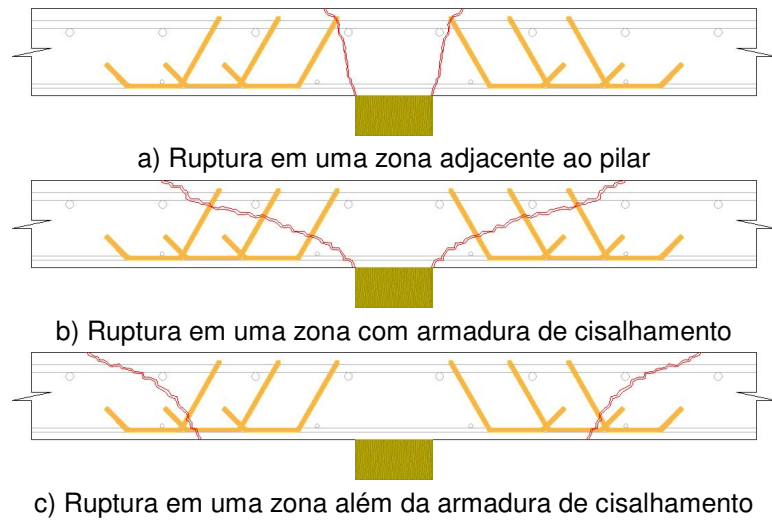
Ruptura por punção em lajes com armadura de cisalhamento CEB-FIP (1991)
